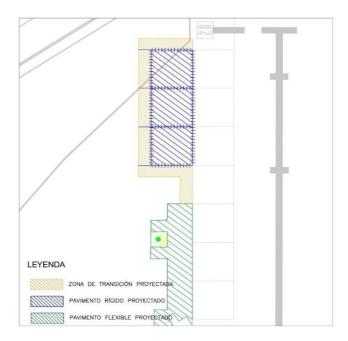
Sectores del pavimento a reparar en la PEA - 28.
